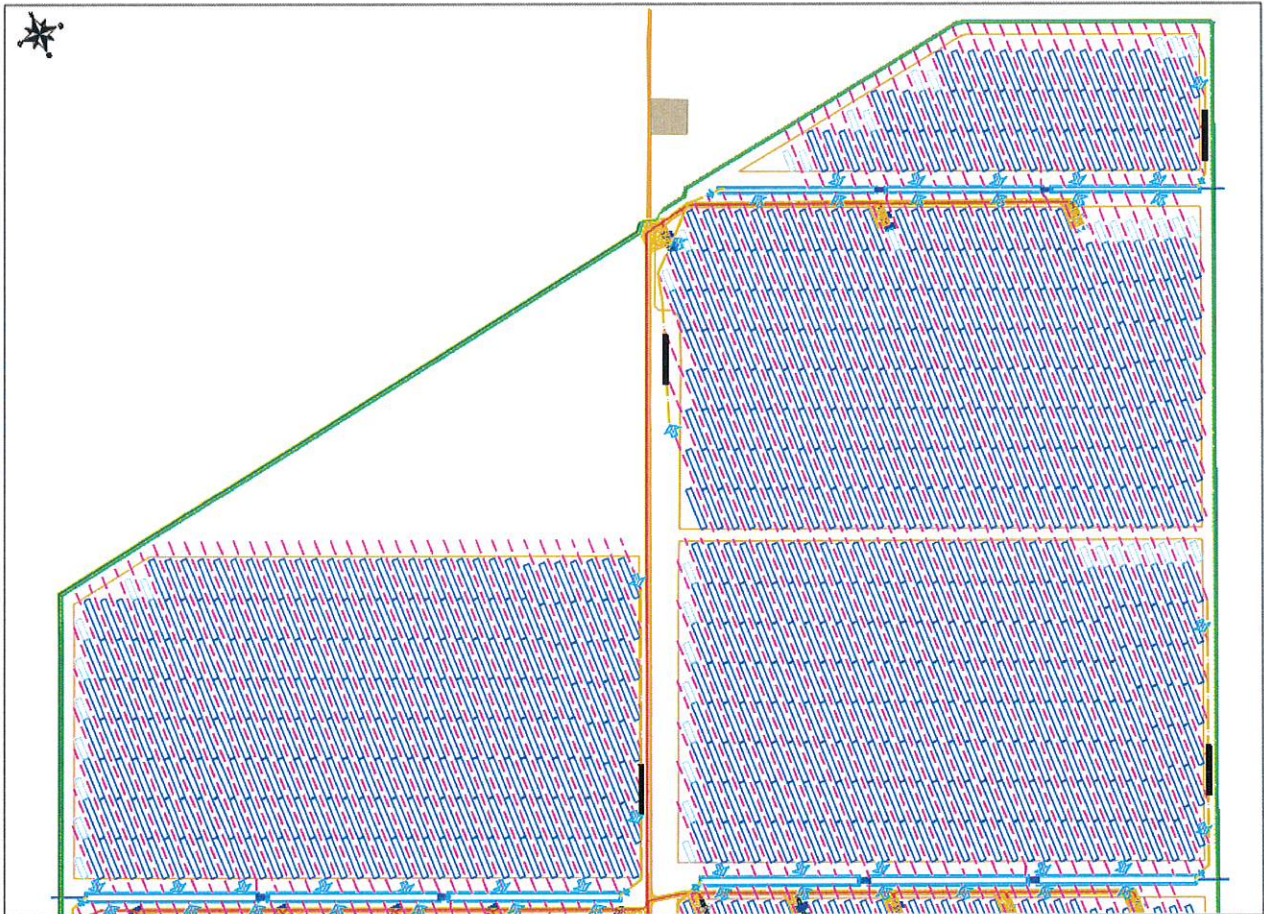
Layout impianto agrivoltaico e sistema di drenaggio – Parte nord
